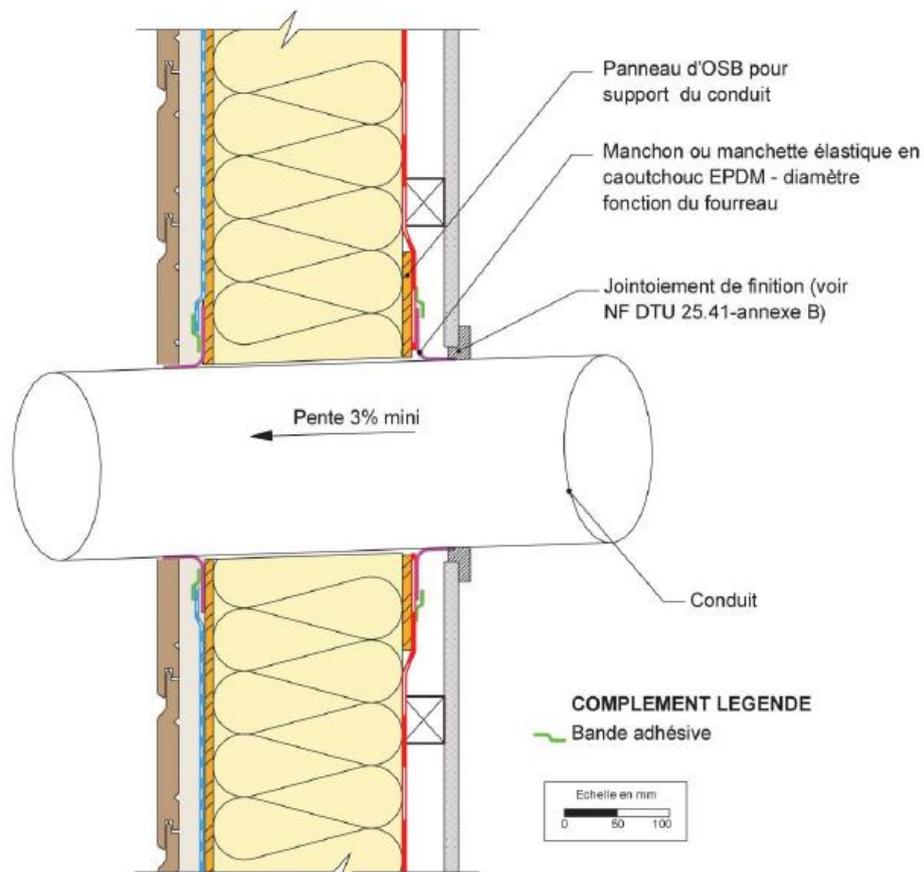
Raccordement de l'étanchéité à l'air et à l'eau en périphérie d'un élément traversant par un manchon EPDM – niveau d'étanchéité Ee1 (coupe verticale)
